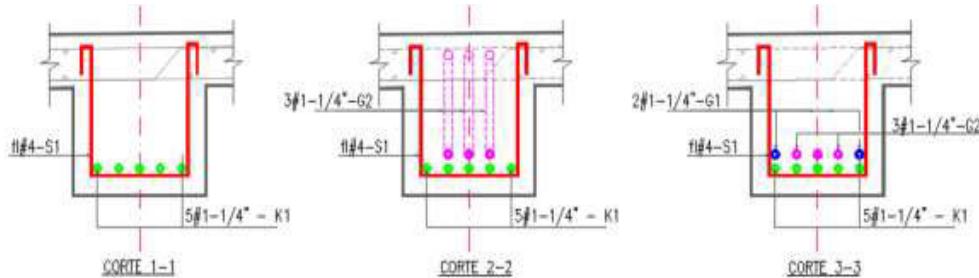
Detalle refuerzo longitudinal viga – VGE – informacion transcripta
